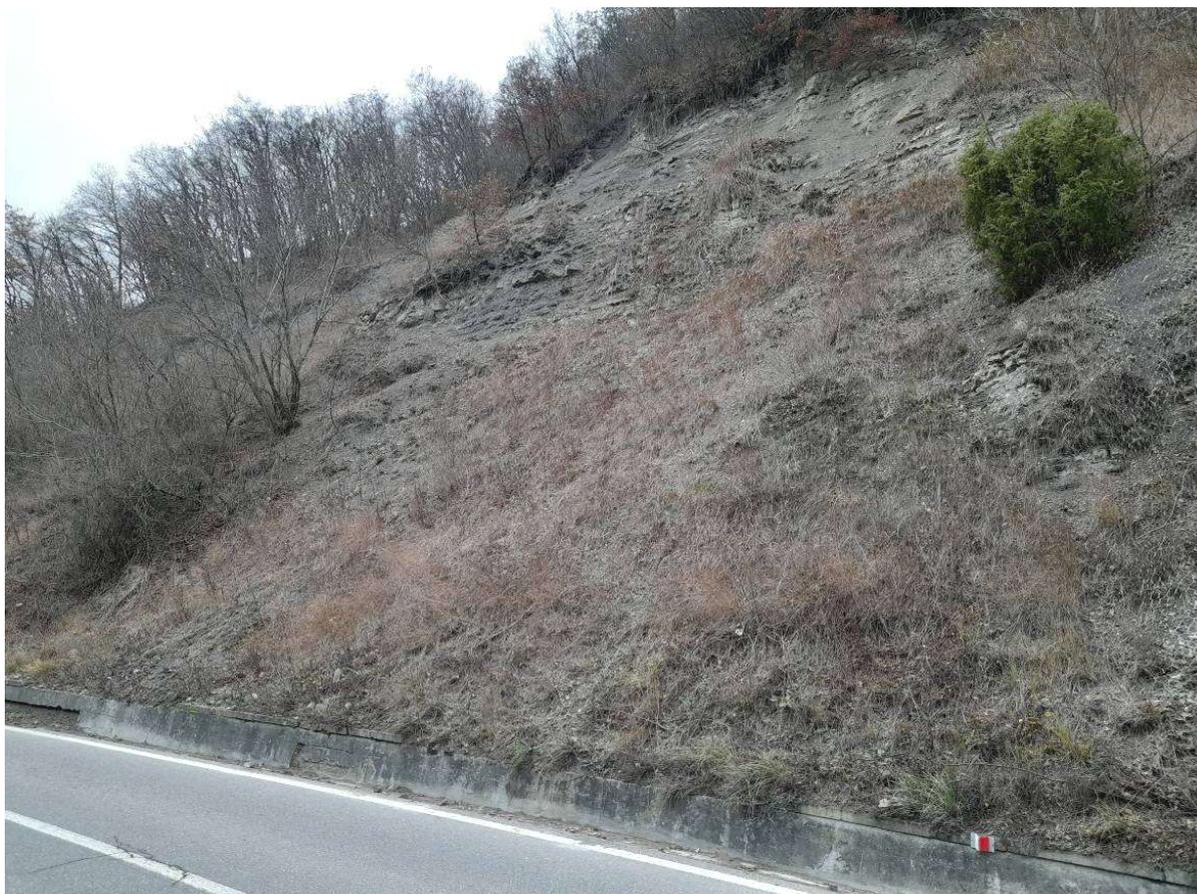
Vista del versante con interruzione della rete metallica di contenimento
